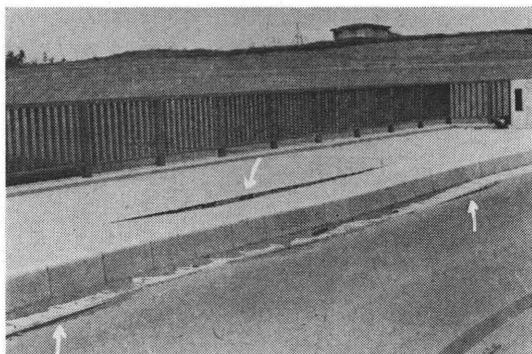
Photo. 1 と同じ。但し、矢印は歩道
